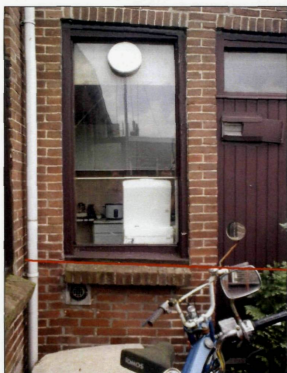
Zichtbare scheefstand in de aanbouw van nr. 40 onderkant raamkozijn.
